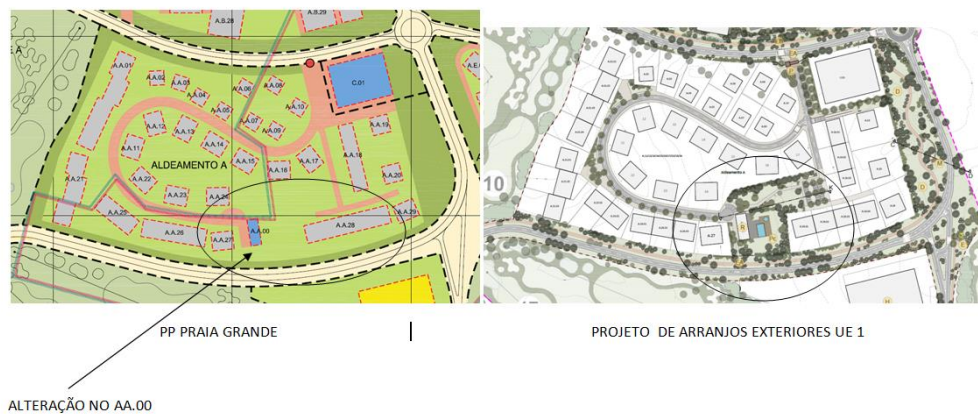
Planta de Implantação do PP da Praia Grande e Planta de Arranjos Exteriores constante no processo posto à consulta em 2022.
